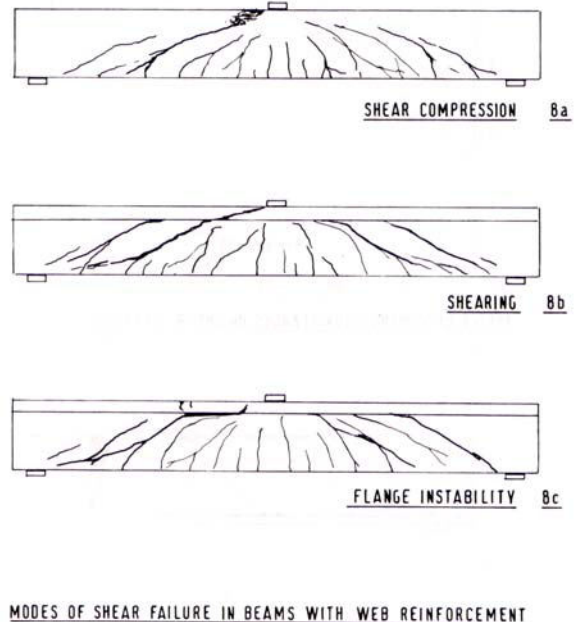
Versagensmodi querkraftbeanspruchter Bauteile nach [code_2]
